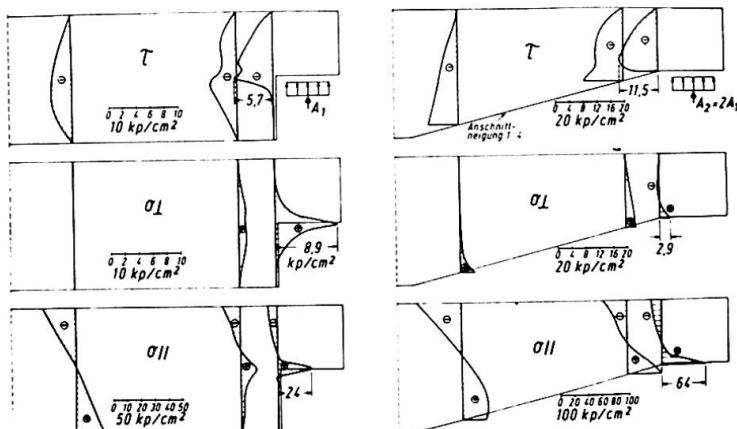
Spannungsverteilungen in ausgeklinkten Brettschichtträgern
